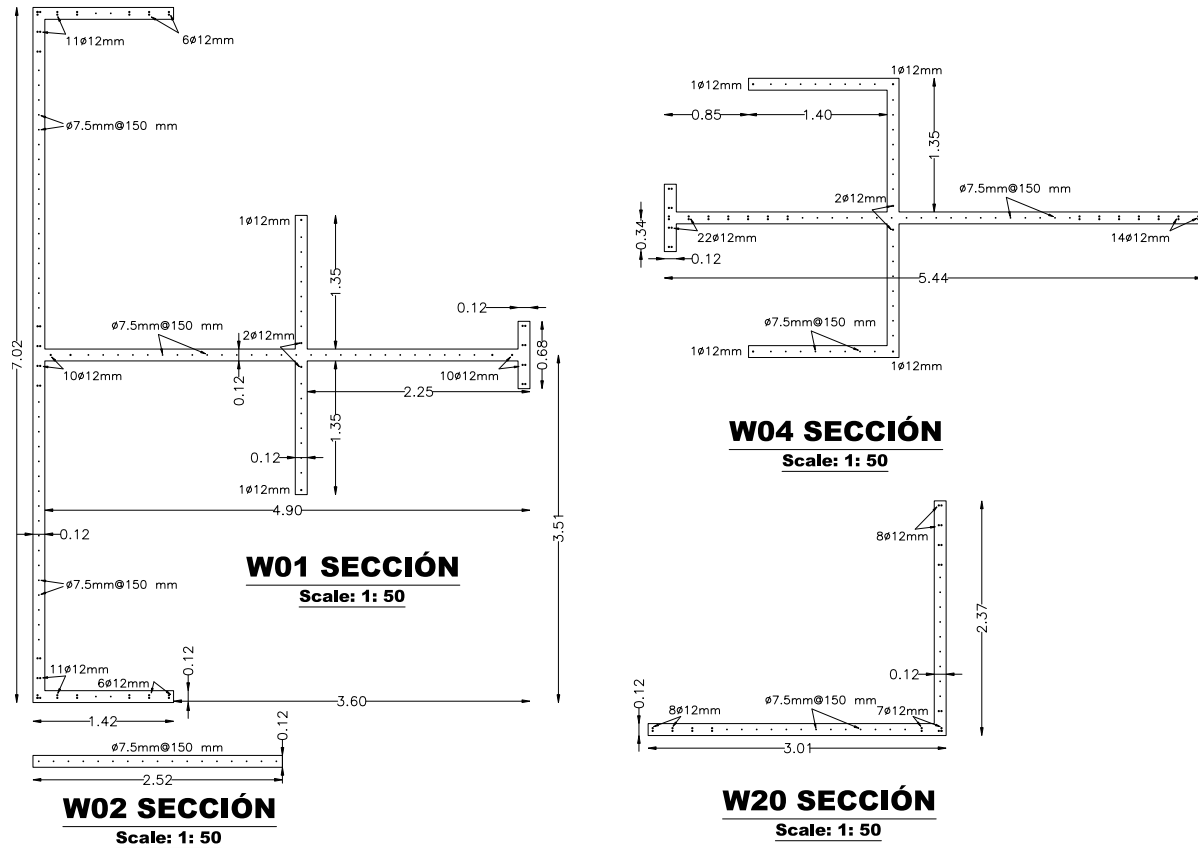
Geometría y refuerzo típico de los muros delgados (a) Muro W01, (b) Muro W02, (c) Muro W04 y (d) Muro W20.
